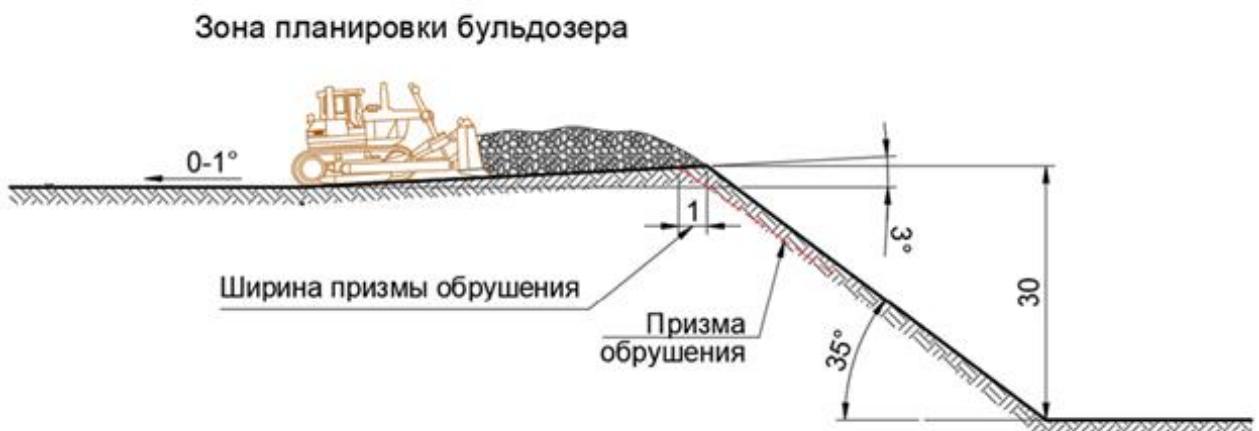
Формирование разгрузочной площадки отвала бульдозером
